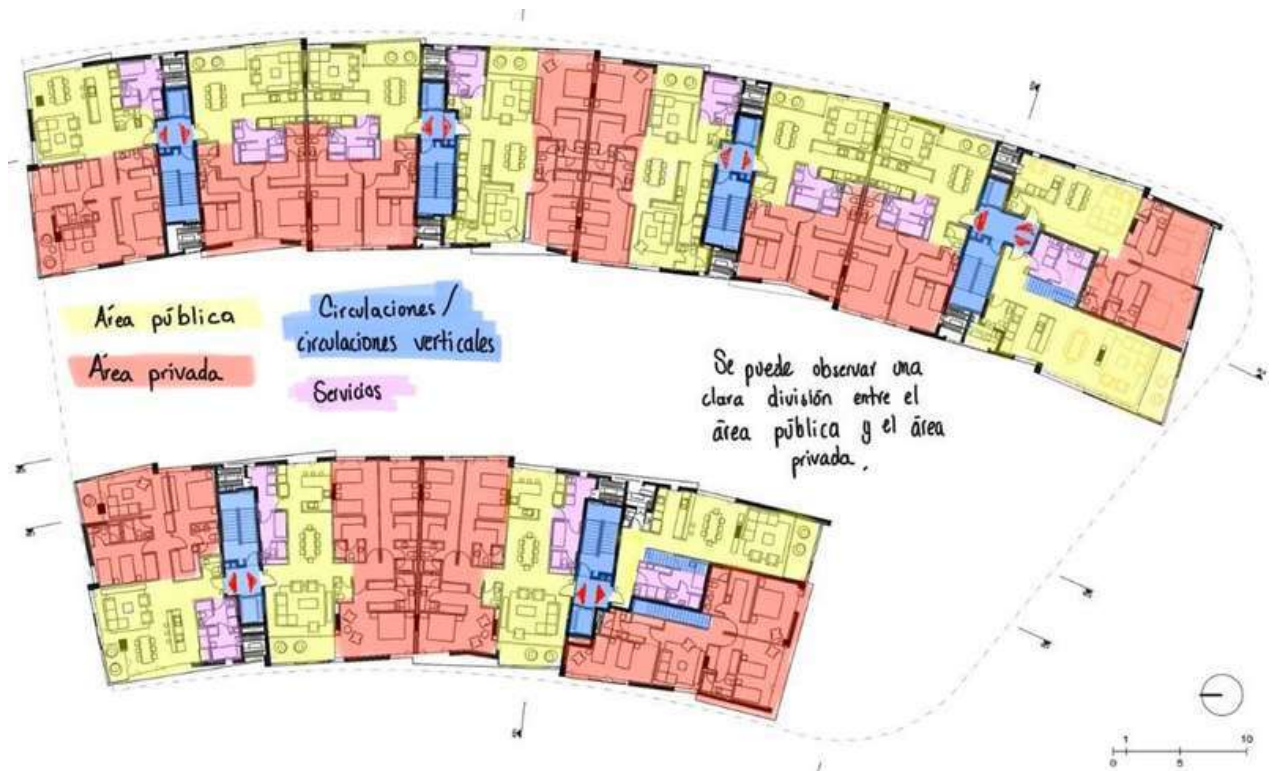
Planta arquitectónica intervenida con zonificación. Fuente: Autoría propia.
